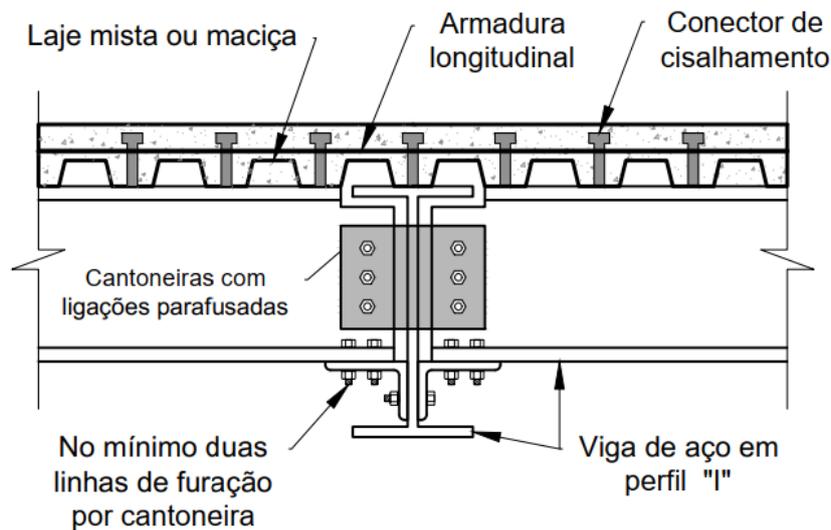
Ligação mista de aço e concreto com cantoneiras parafusadas na alma e na mesa inferior da viga apoiada.
